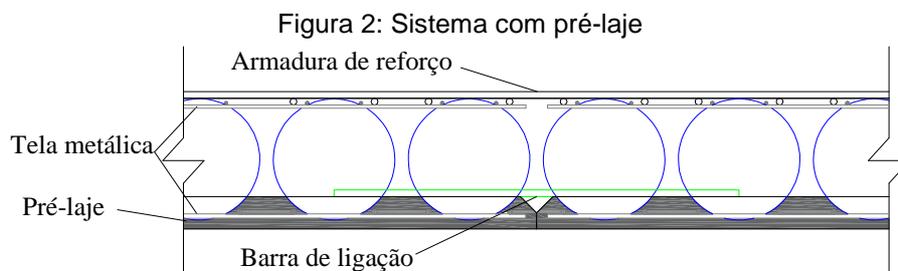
Exemplo de laje *BubbleDeck* com pré-laje
